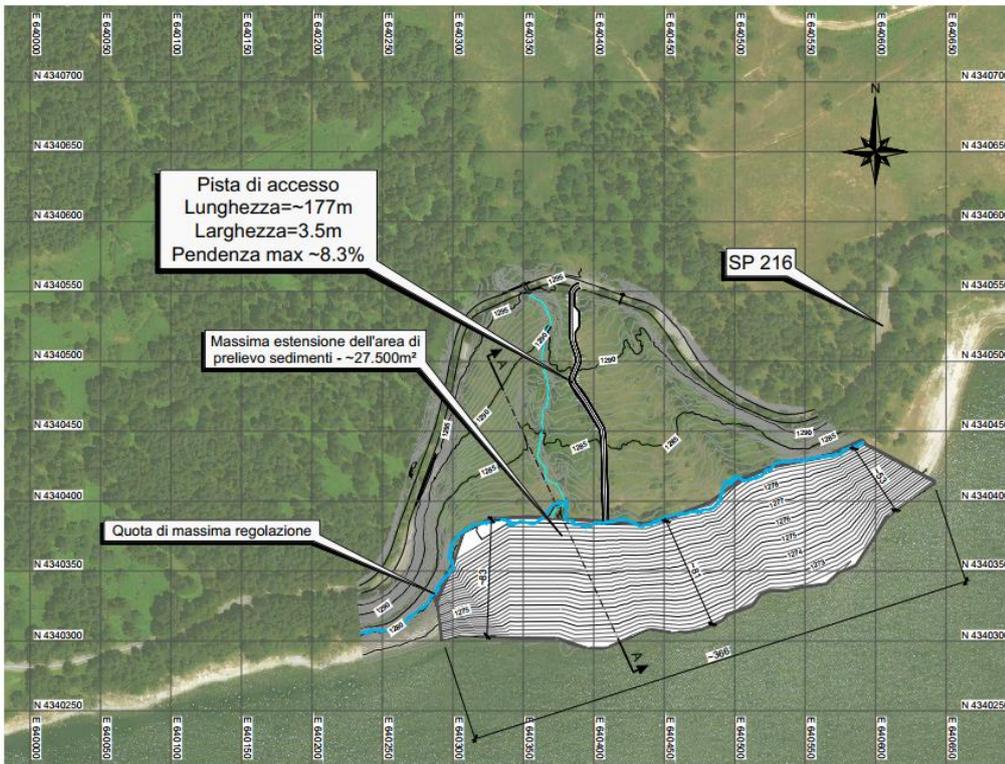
sito di prelievo Tout-Venant (CV), sito 2, planimetria
